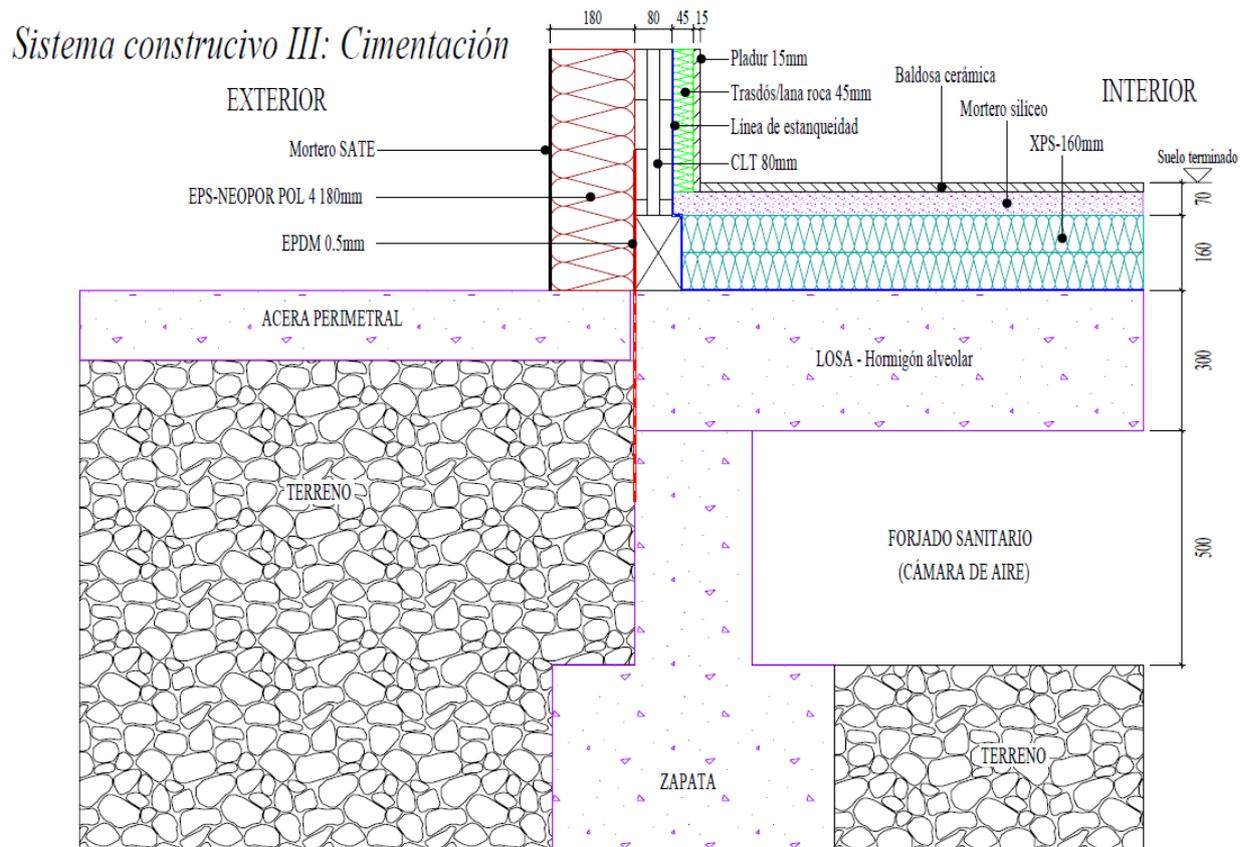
Detalle constructivo de la cimentación: aislamiento sobre losa y forjado sanitario
